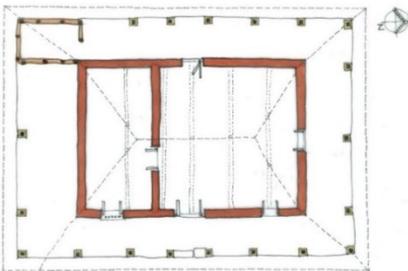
Planta rectangular con galerías perimetrales, caso 4.
